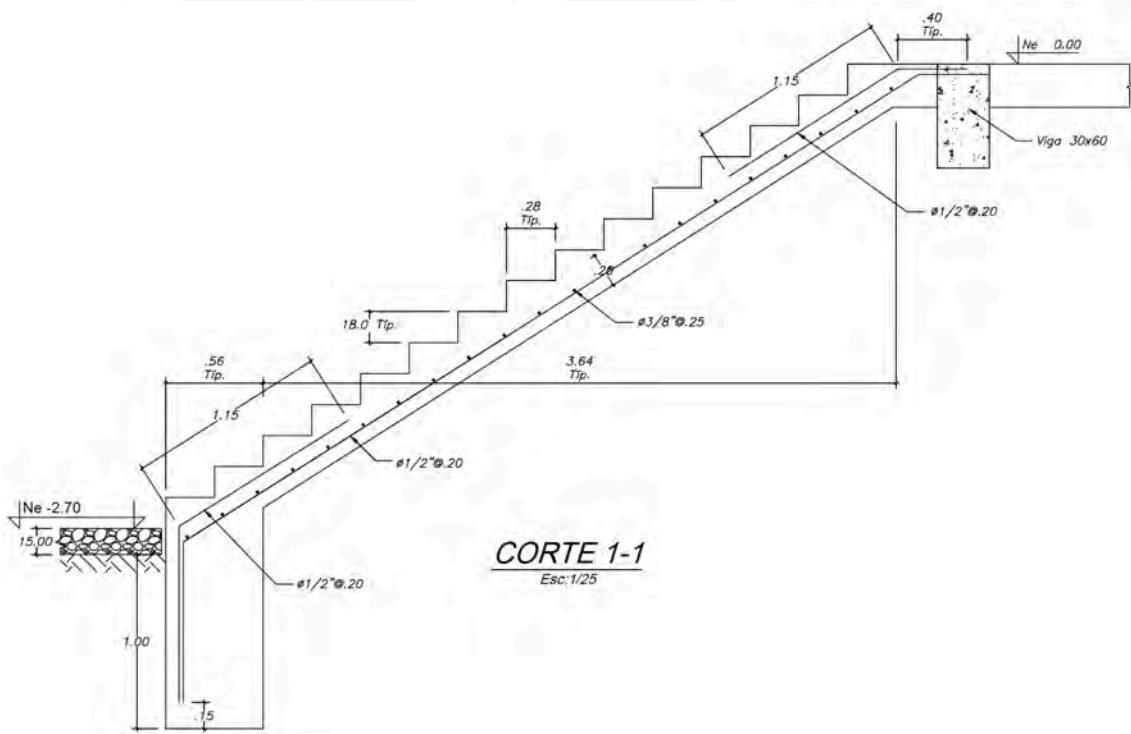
Elevación del Corte 1-1 de la Escalera
